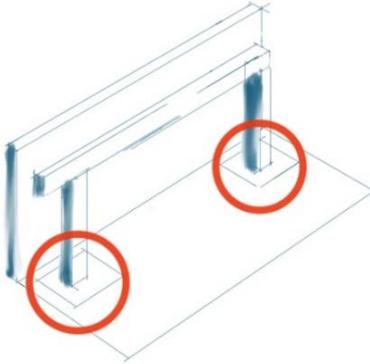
Cimentación aislada. Fuente: Elaboración propia
